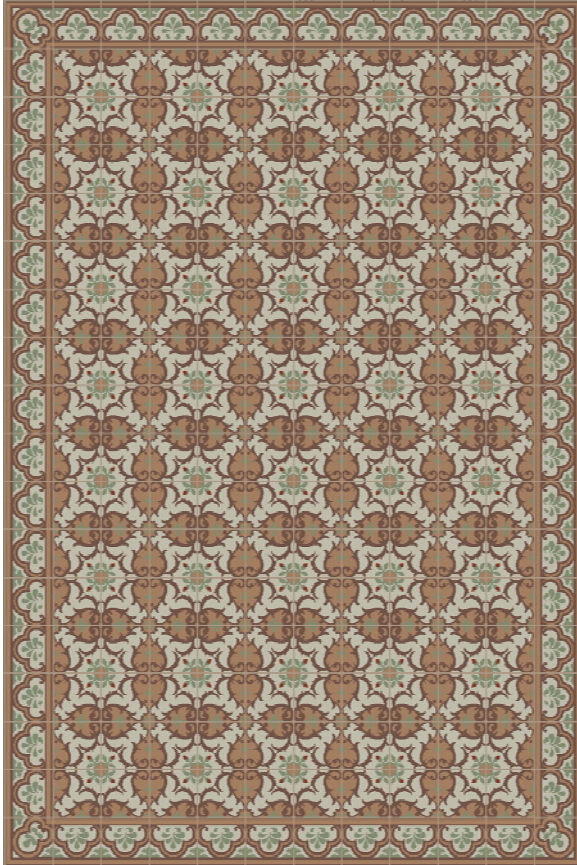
Levantamiento gráfico pavimento. Fuente propia.
